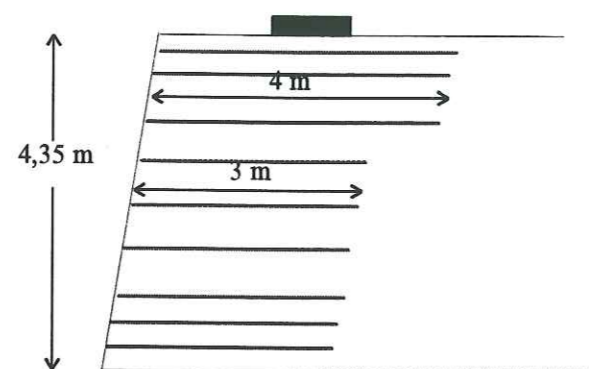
Prédimensionnement - 10 couches - 3 nappes hautes de 4 m de longueur
